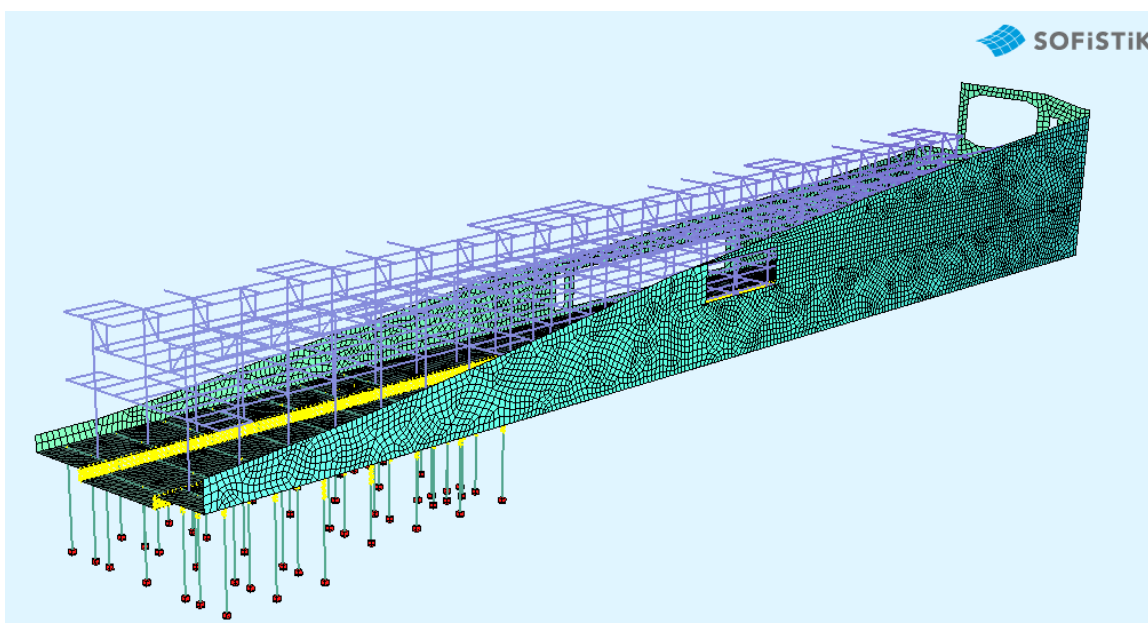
Vista 3D do modelo de cálculo da estação – corpo principal e estrutura interna (vista Norte - Sul)
